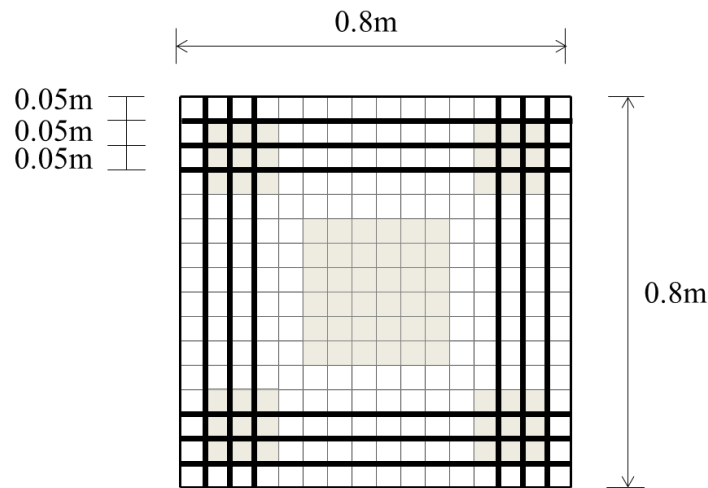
Vista en planta de la disposición de armado, y posición de columna y pilotes
